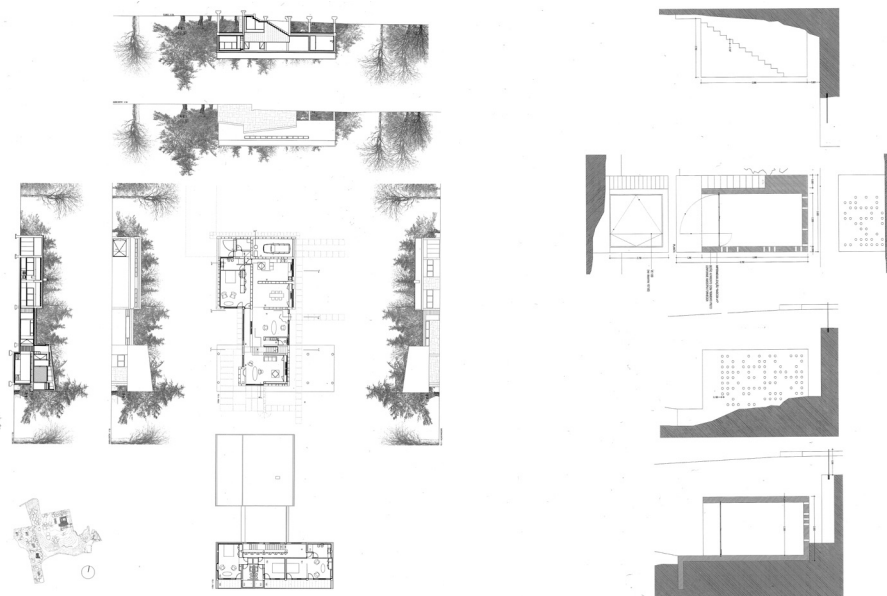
Plantas cortes e alçados de uma das Casas do Pessoal Dirigente e da casa das máquinas da Piscina - Segunda proposta de intervenção.
